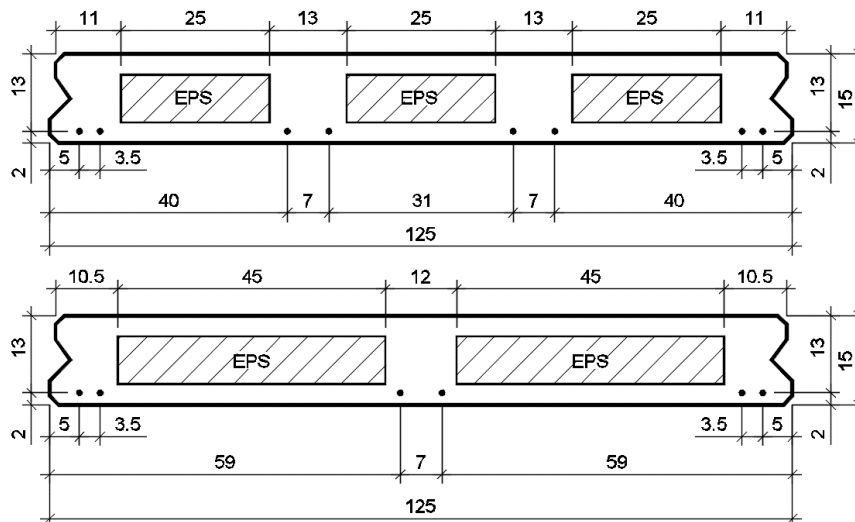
Detalhe do posicionamento da armadura transversal.
